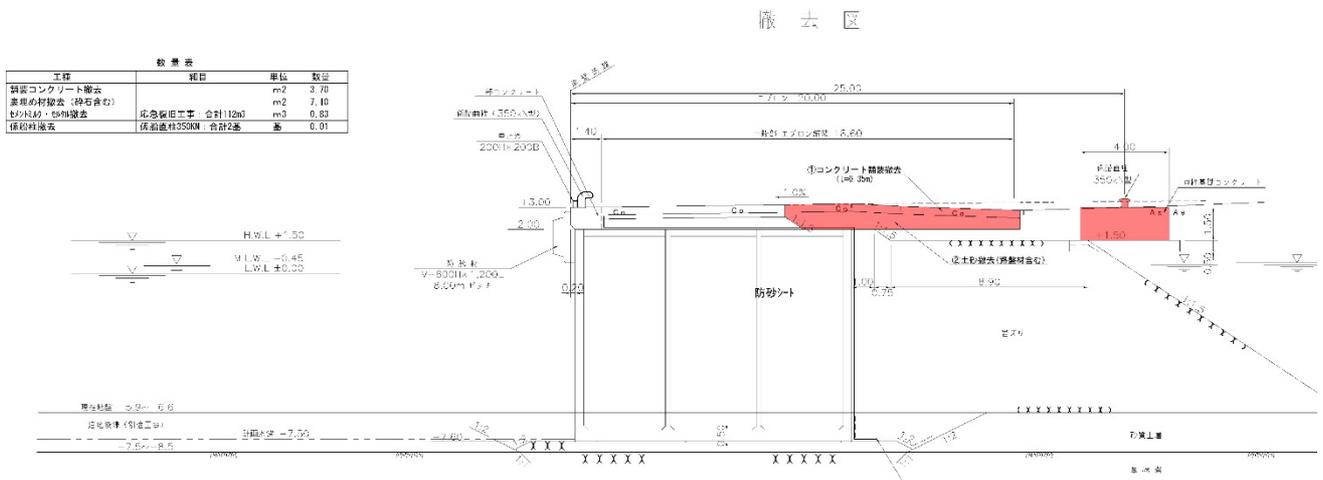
237 No.20 常陸那珂港区_中央ふ頭地区岸壁 (-7.5m) の断面図 (復旧後)
